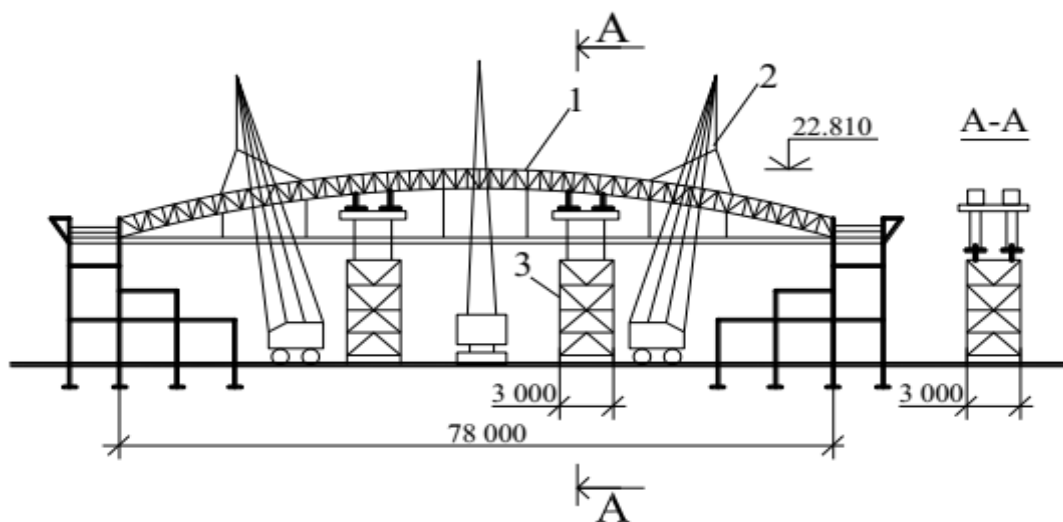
Схема монтажу арочного покриття: 1 - елемент арки; 2 - монтажний кран; 3 – рухома монтажна опора
